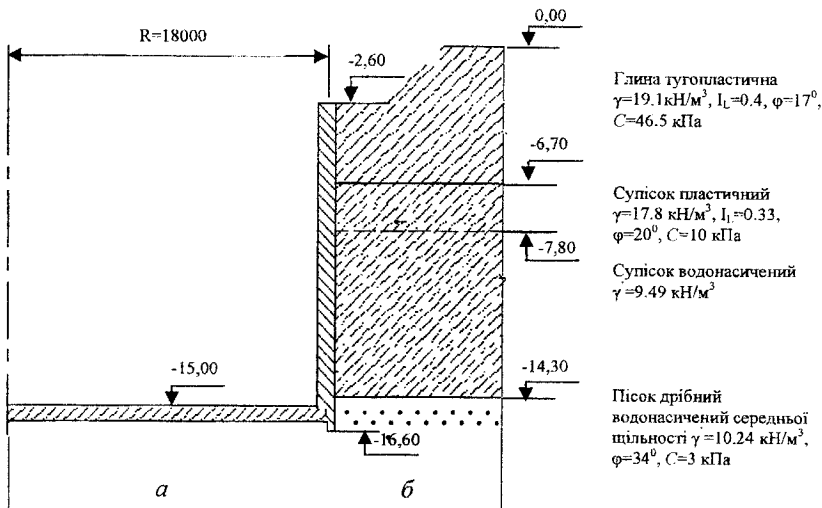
Схема опускного колодезя (а), ґрунтові умови (б)
